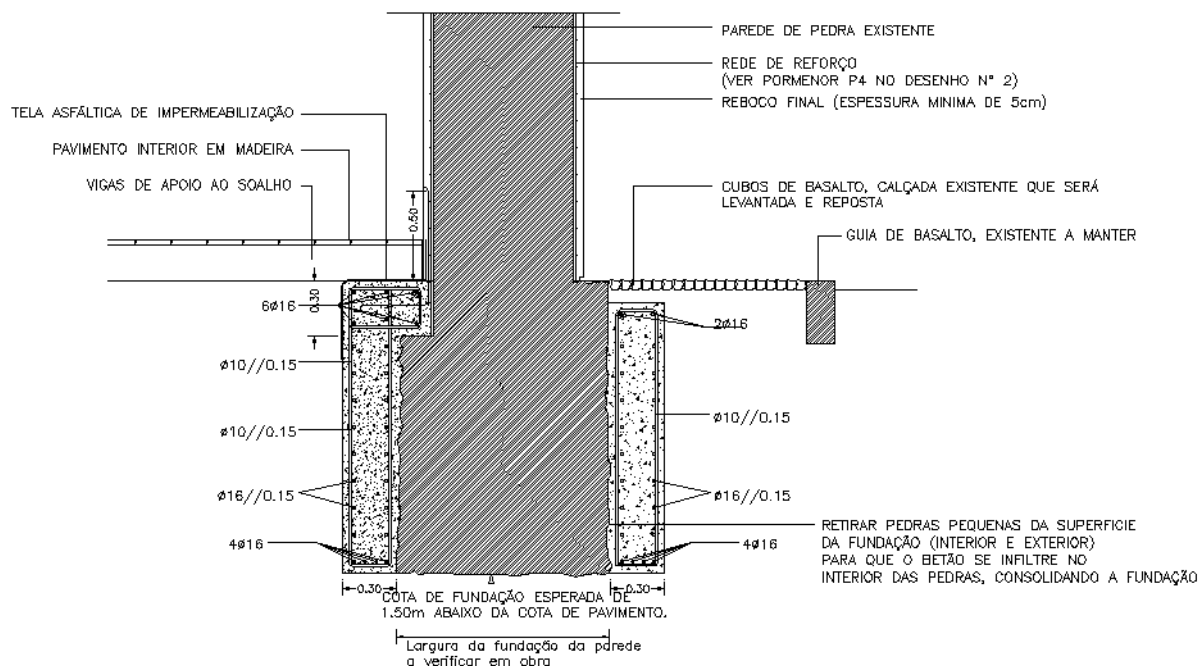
Pormenor de reforço das fundações das paredes exteriores por uma fundação contínua [31].
